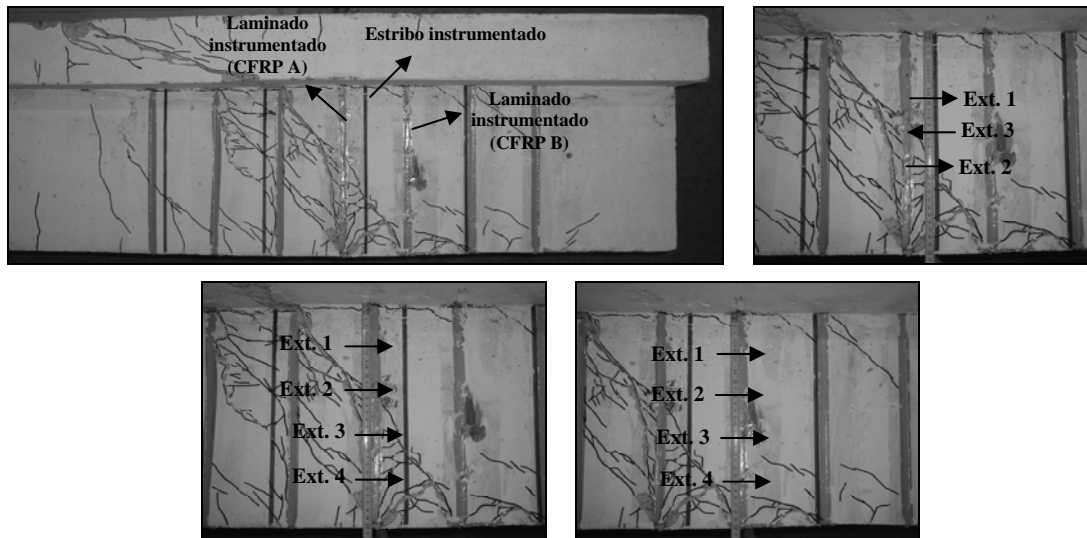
Localização dos extensómetros no laminado e estribo instrumentados da viga 4S-7LV-C.
